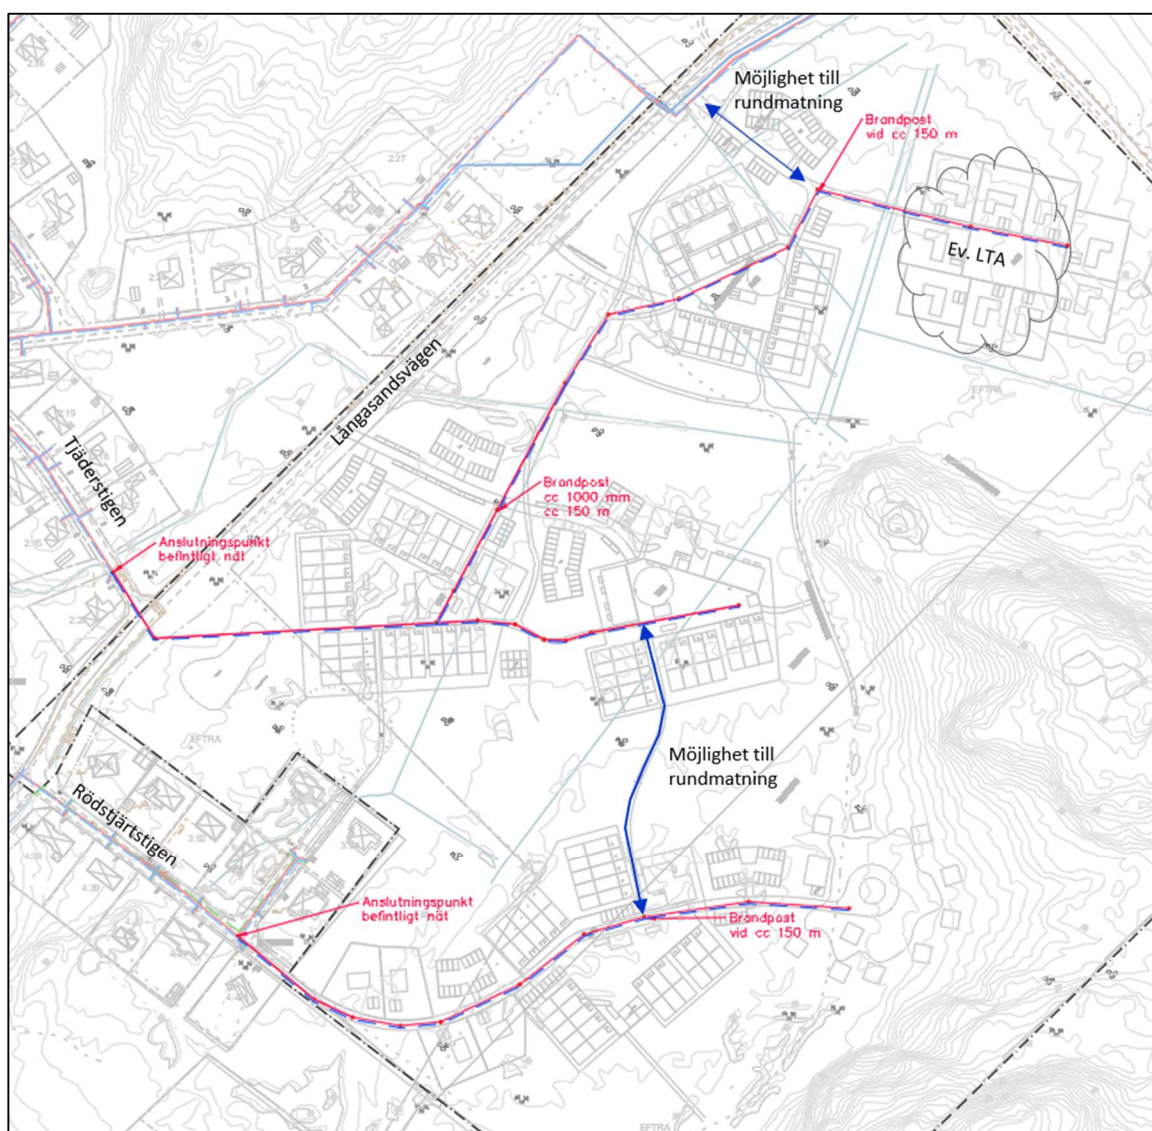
Illustrationsplan erhållet 2022-12-02 över planområdet och föreslagna byggnation.
